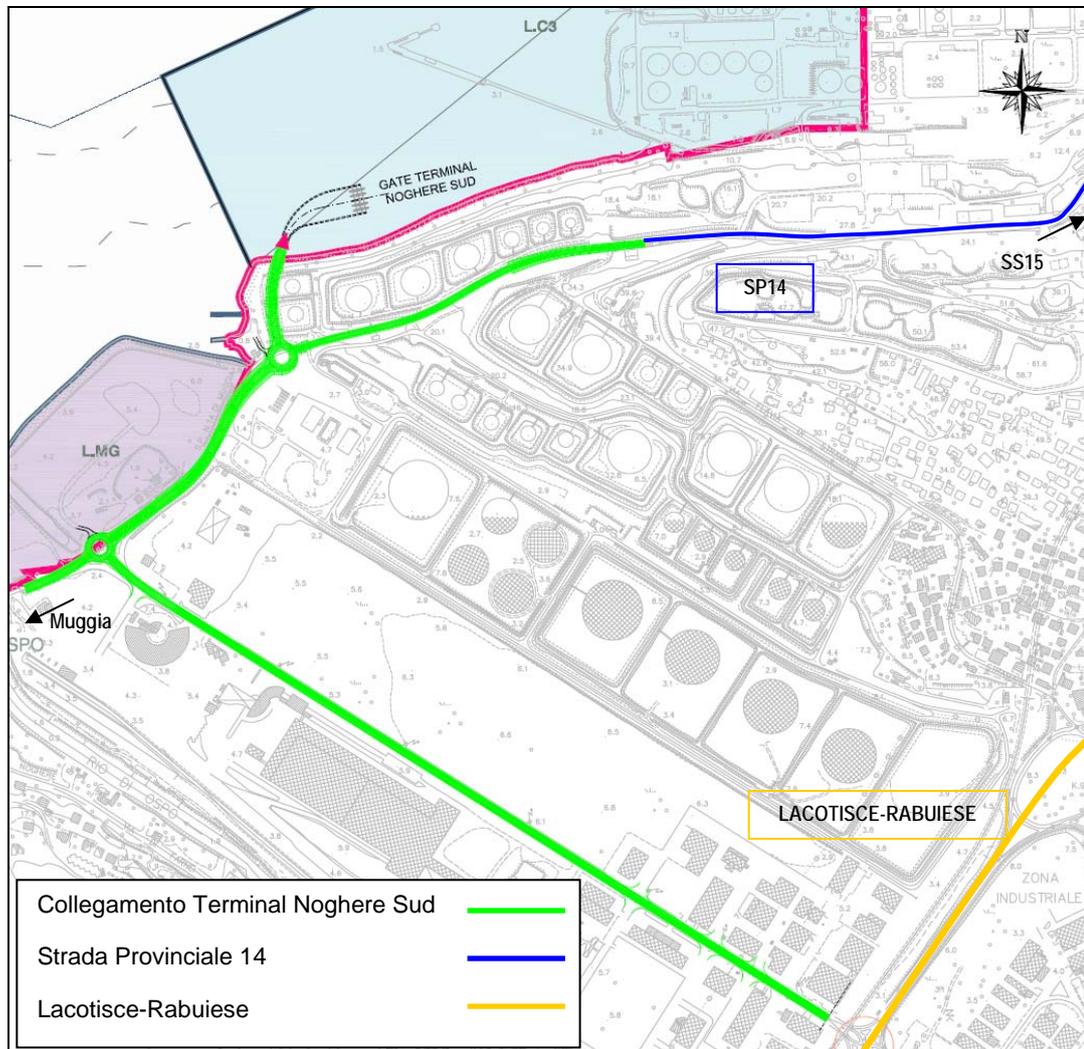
LOCALIZZAZIONE TRACCIATO COLLEGAMENTO SUD
